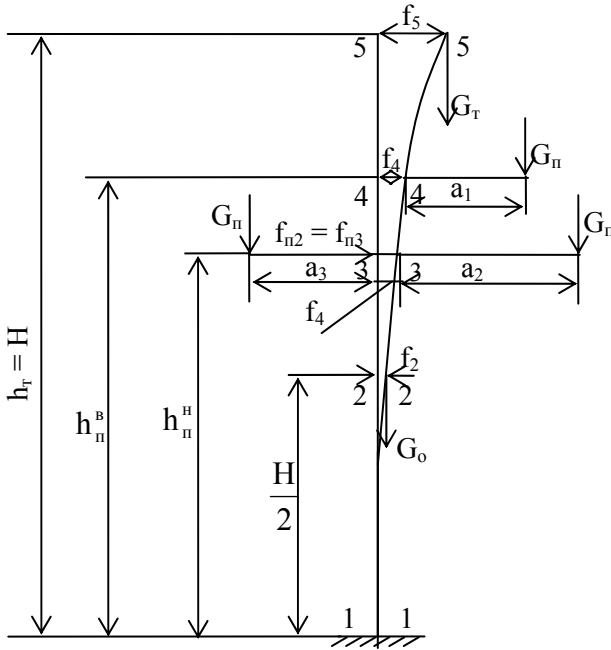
Деформированная схема одноэтажной железобетонной опоры:
